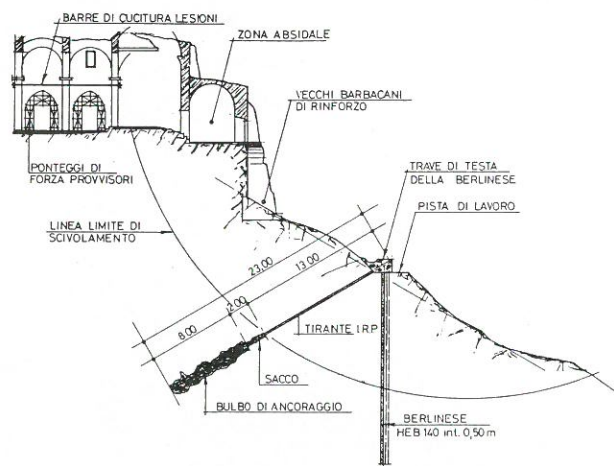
Sezione in asse Chiesa. La linea di scivolamento del versante e lo schema dell'intervento di stabilizzazione.
